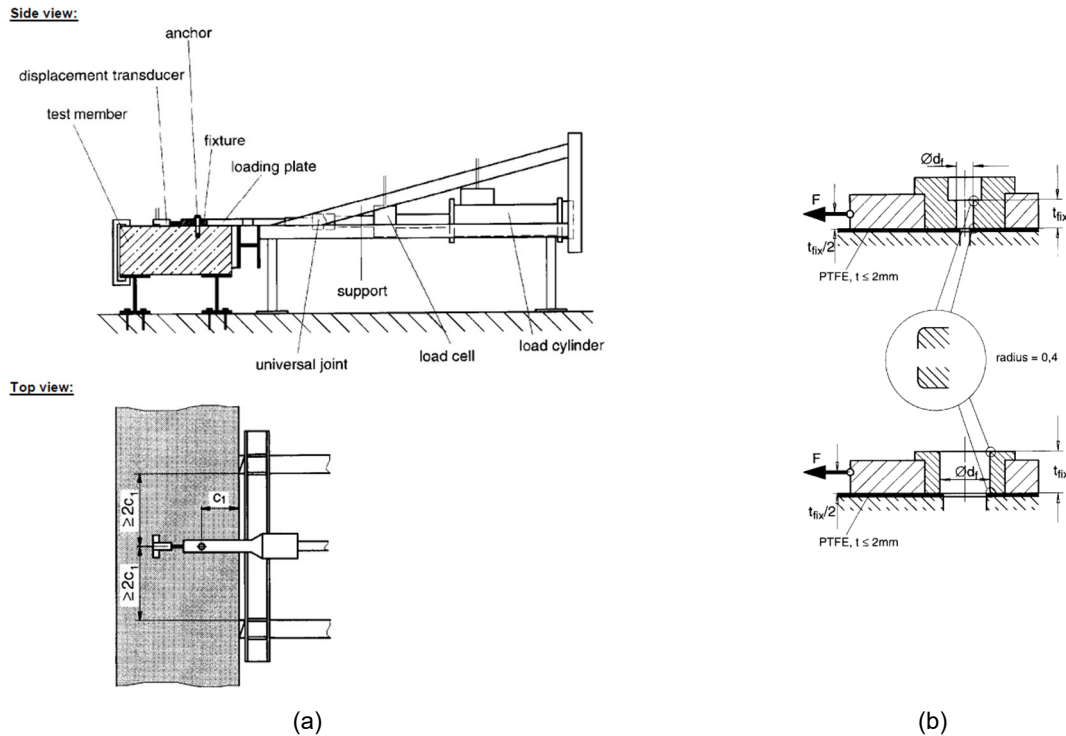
Querzugversuchsskizze: (a) Versuchsaufbau, (b) Querzugplatte mit Passzylinder, aus: *Technical Report 048, S. 9-10
